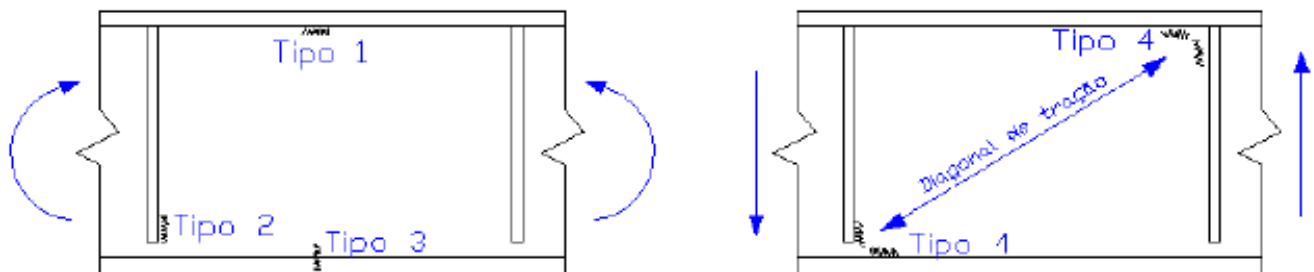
Fissuras por fadiga observadas em pontes metálicas.
